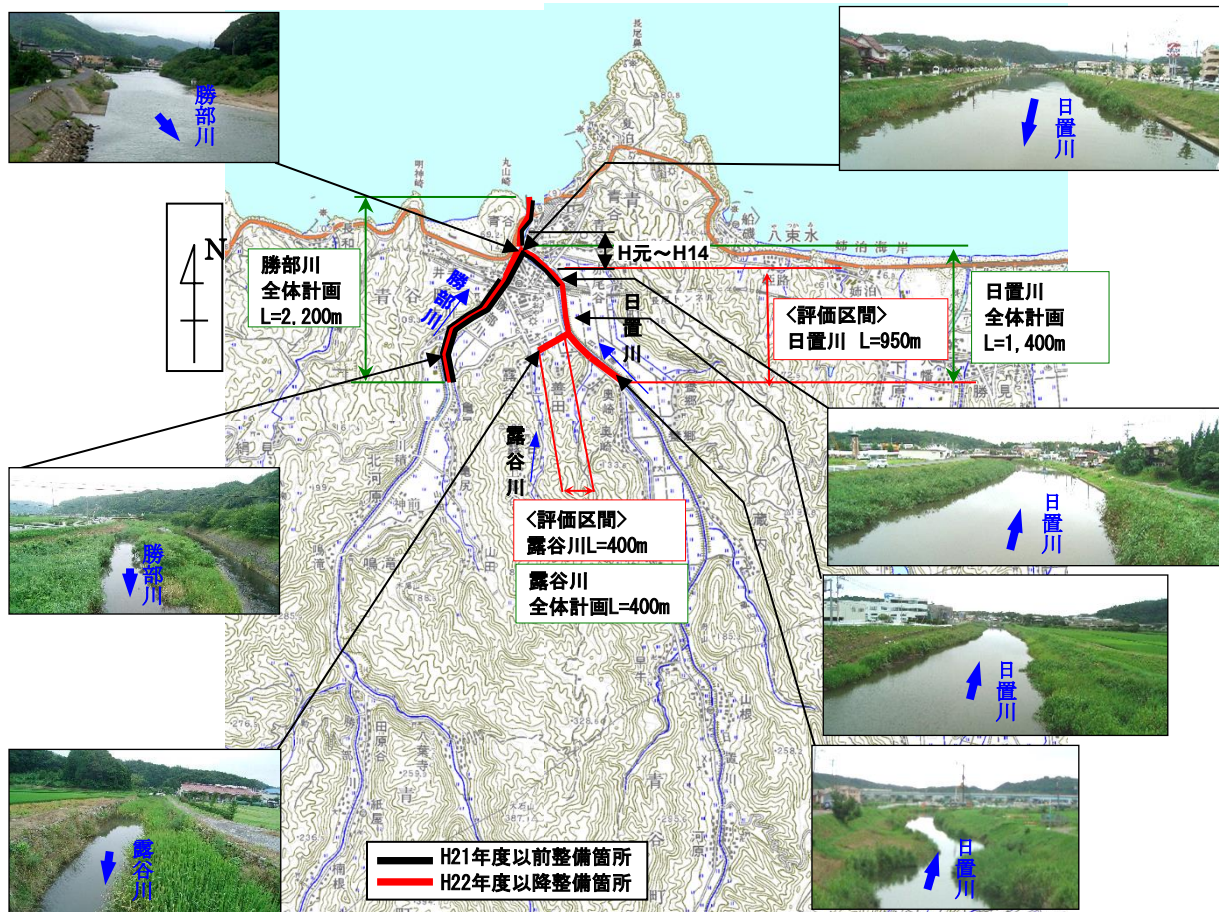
勝部川総合流域防災事業(日置川・露谷川) 概要平面図
